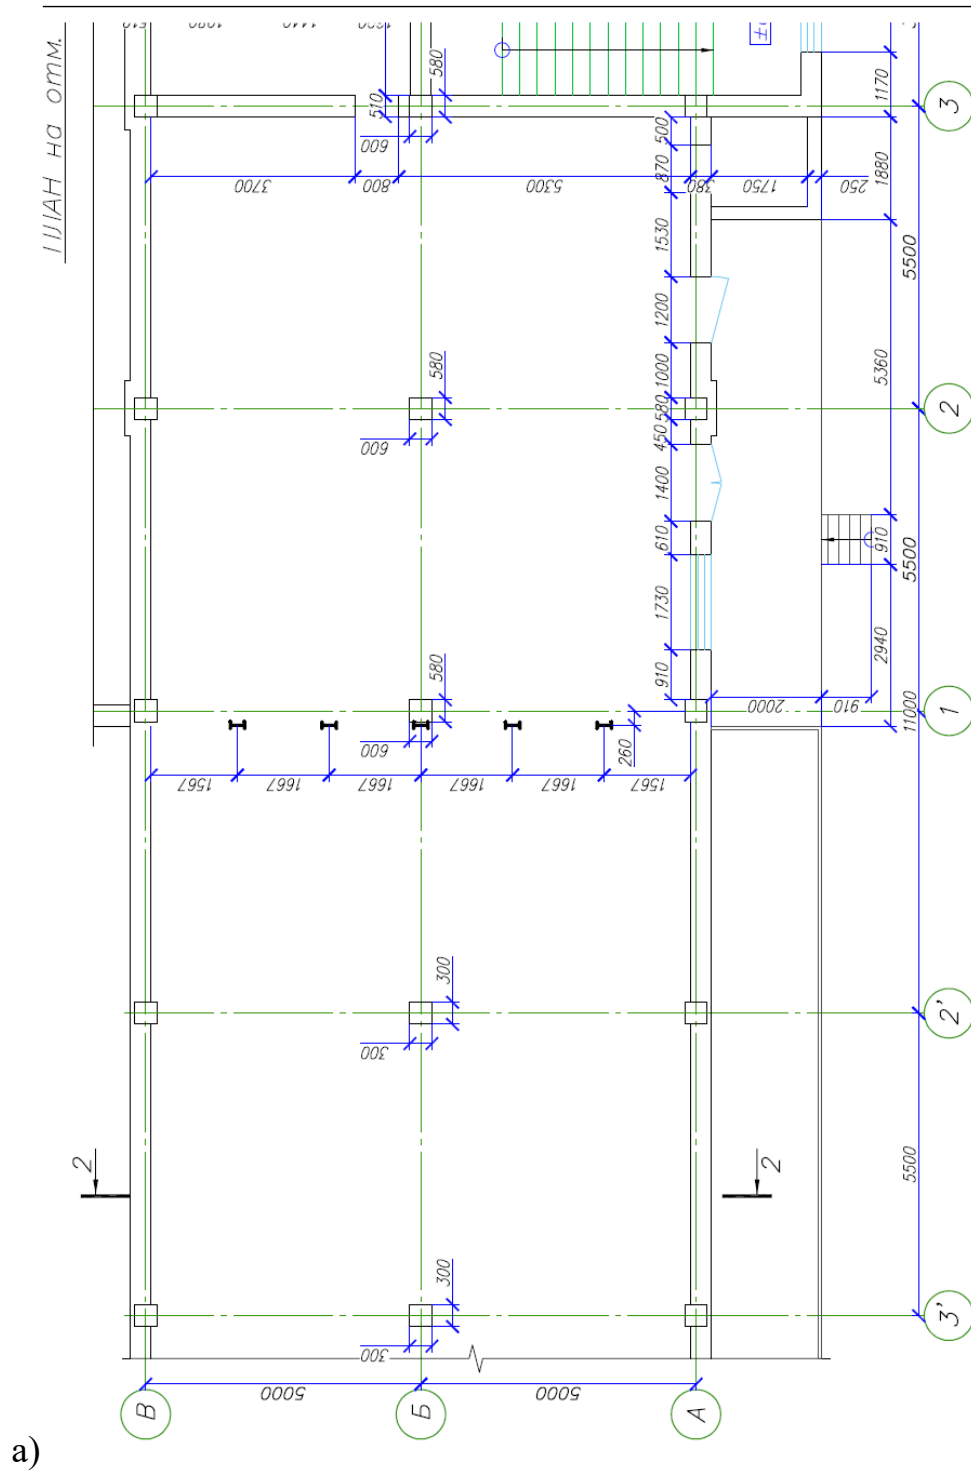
План будівлі на відм. 1,200. Фрагмент а
